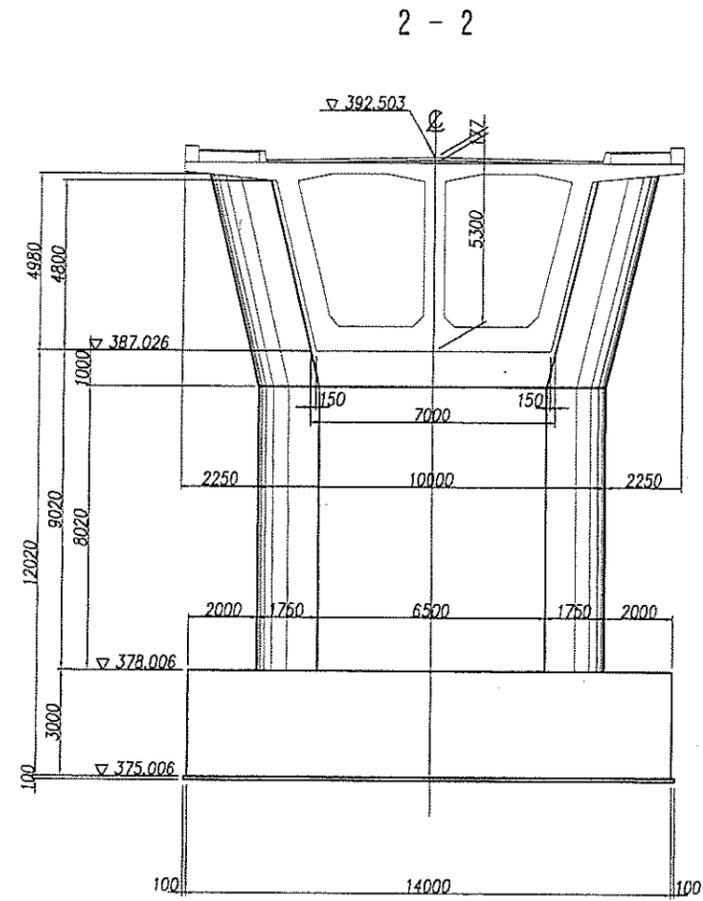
Plano Estructural de La Base del Puente A2 (2)
